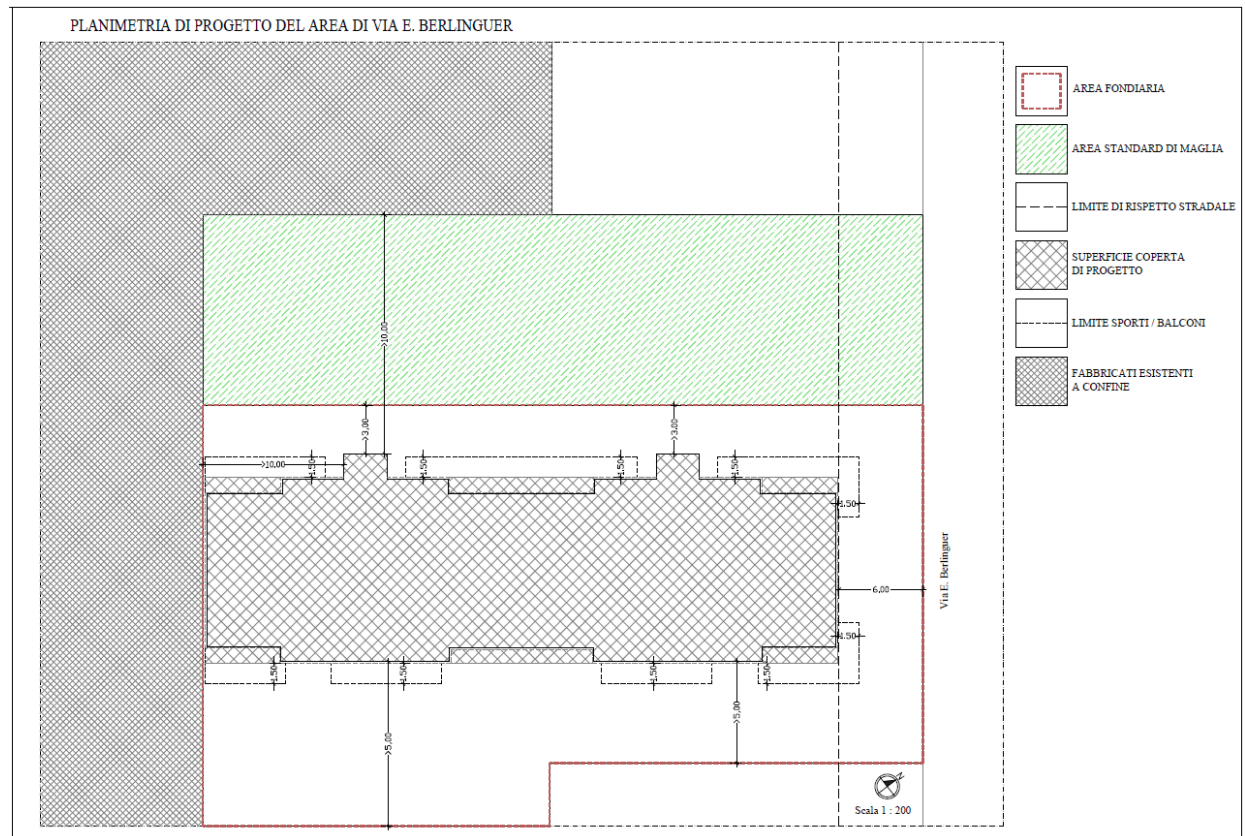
Planimetria e sezione di progetto area edificatoria
